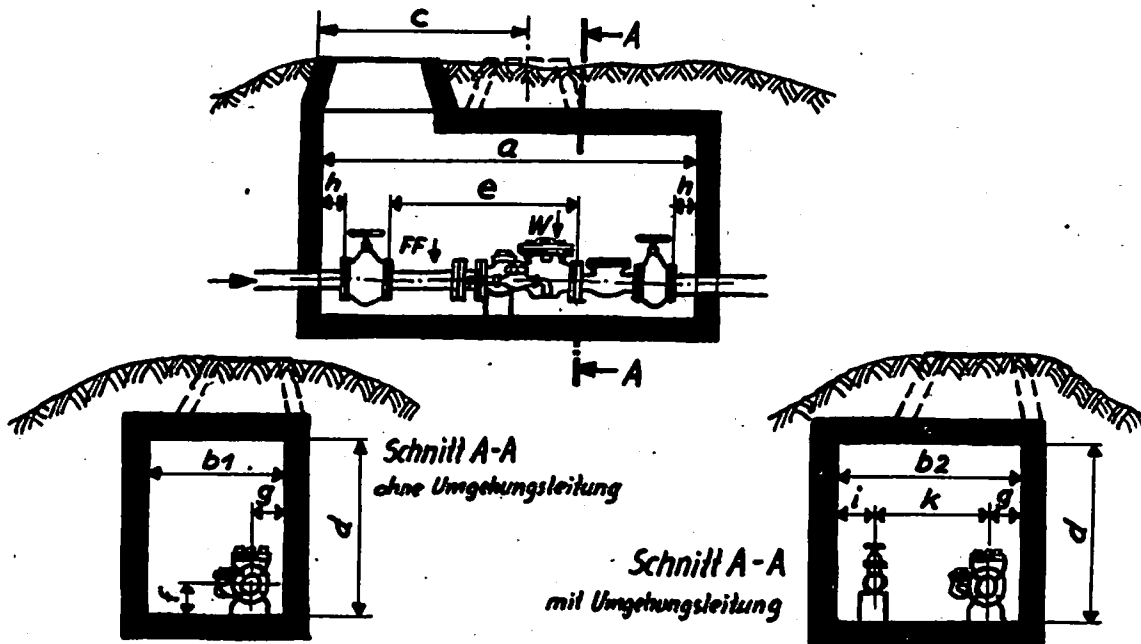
Darstellung der Raum- und Einbaumaße gemäß Tabelle 2
